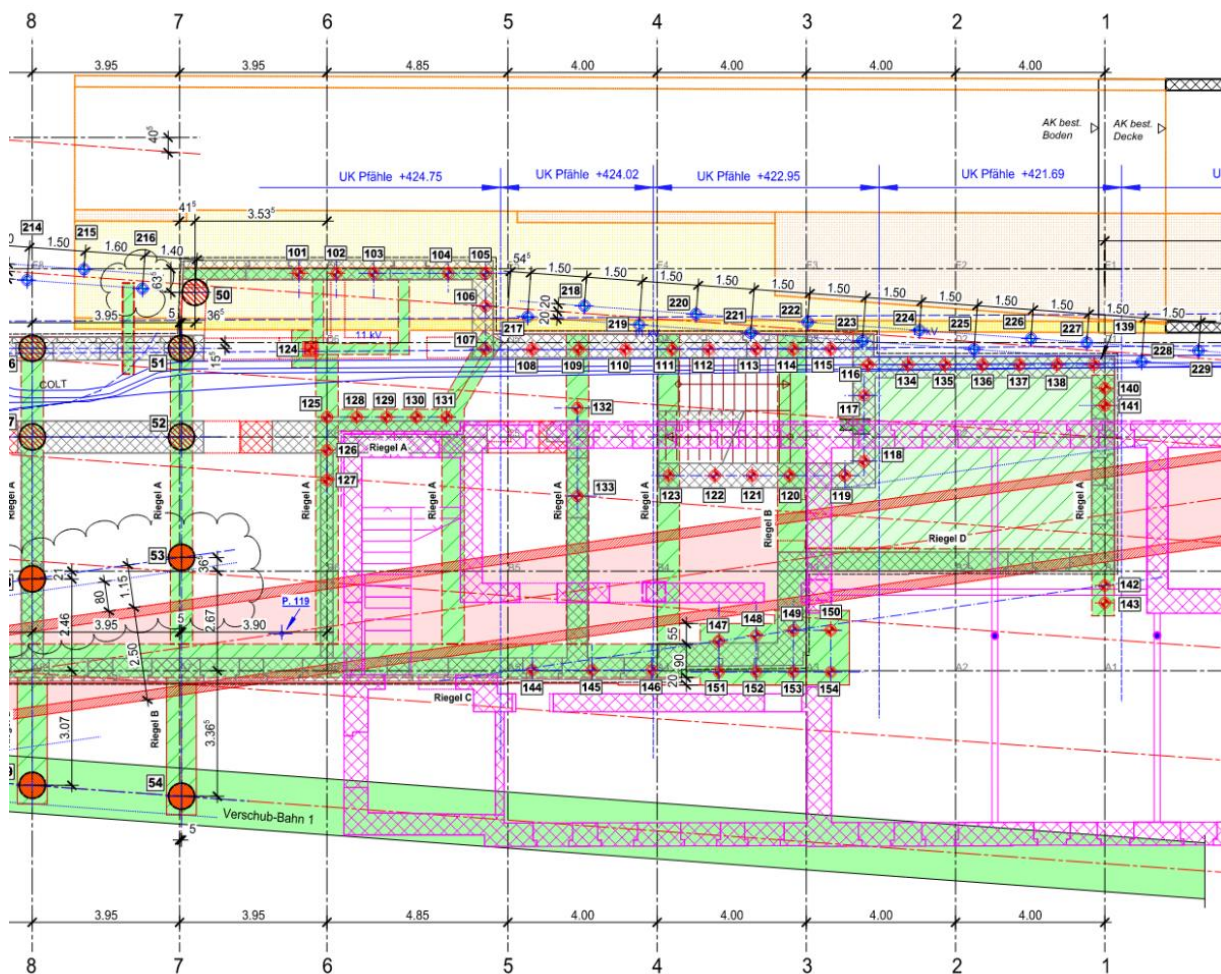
Plano detallado de zona solapada nueva y antiguo posición del edificio
